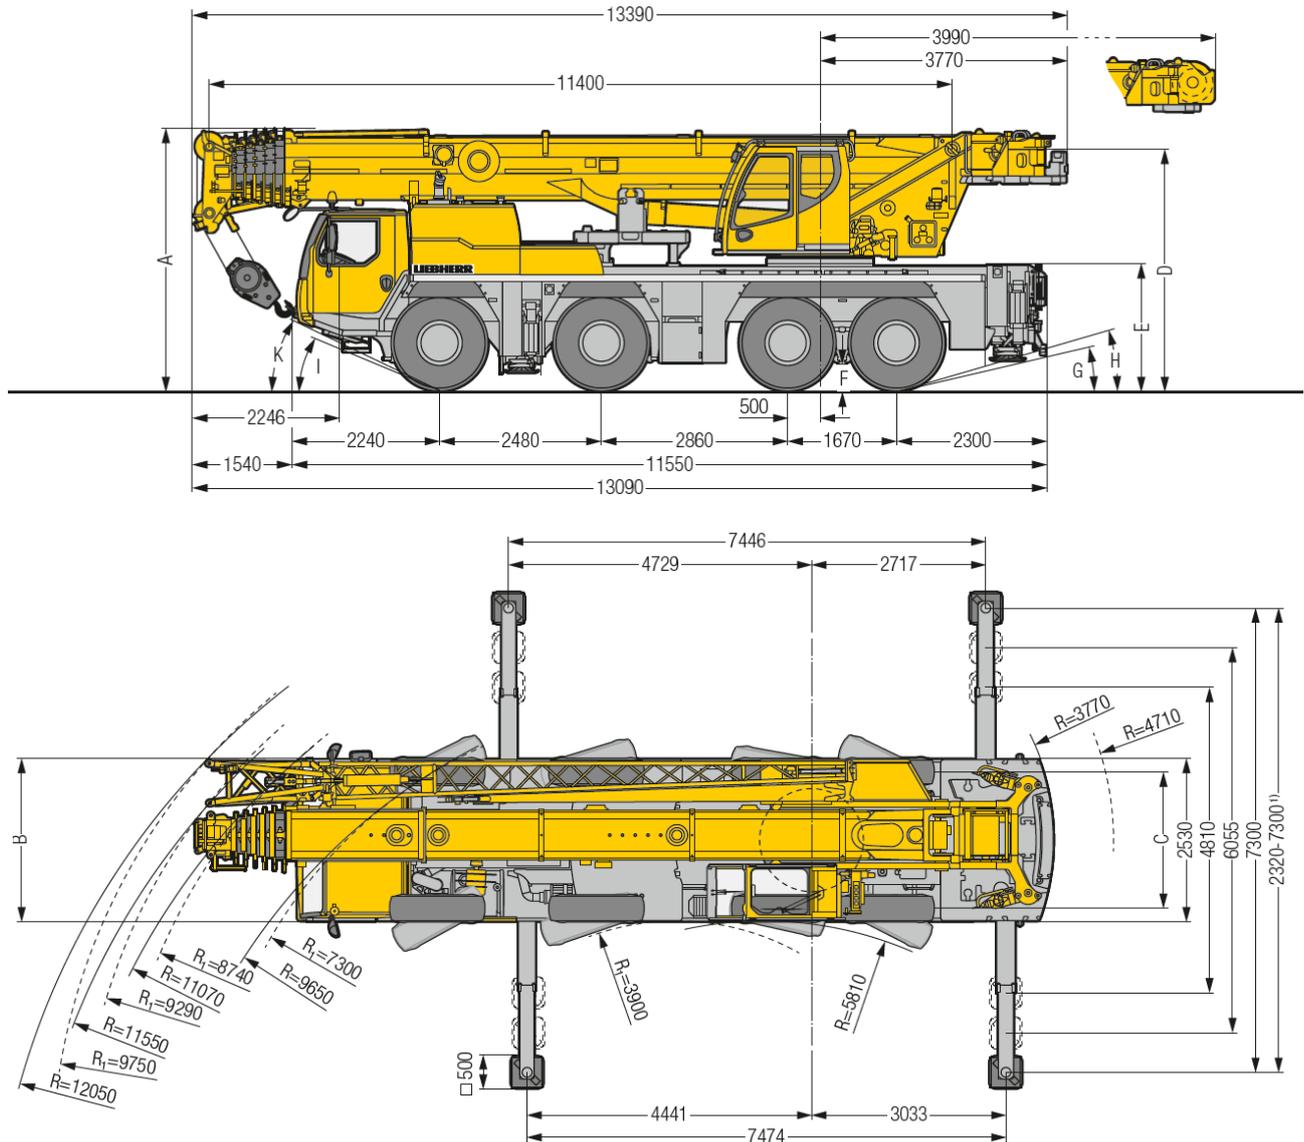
Alzado y Planta de Grúa Autopropulsada de 90tn
